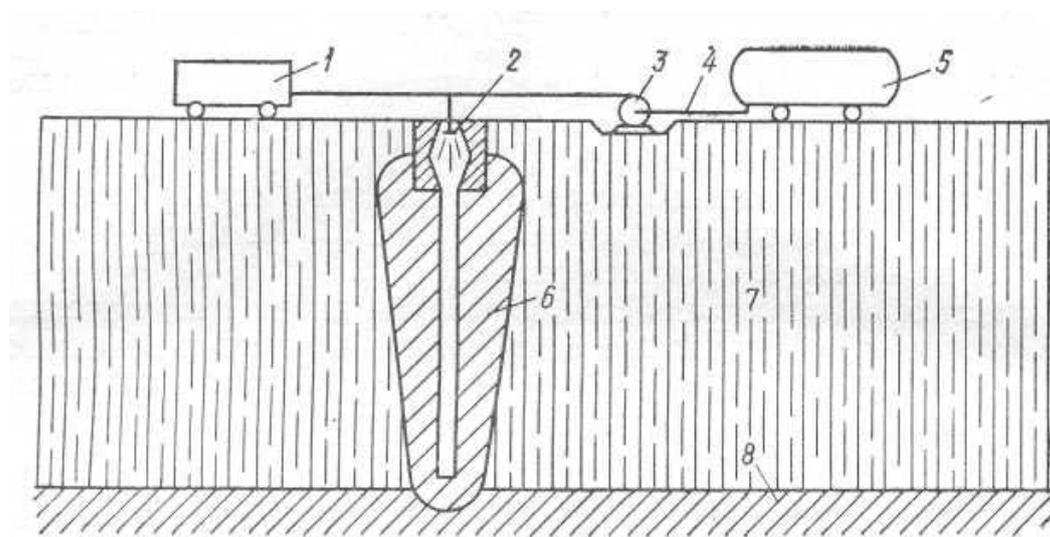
Термическое закрепление свободного массива грунта: 1 – компрессор; 2 – форсунка; 3 – насос для подачи топлива; 4 – трубопровод; 5 – емкость с топливом; 6 – закрепленный грунт; 7 – лессовый грунт; 8 – непросадочный грунт
